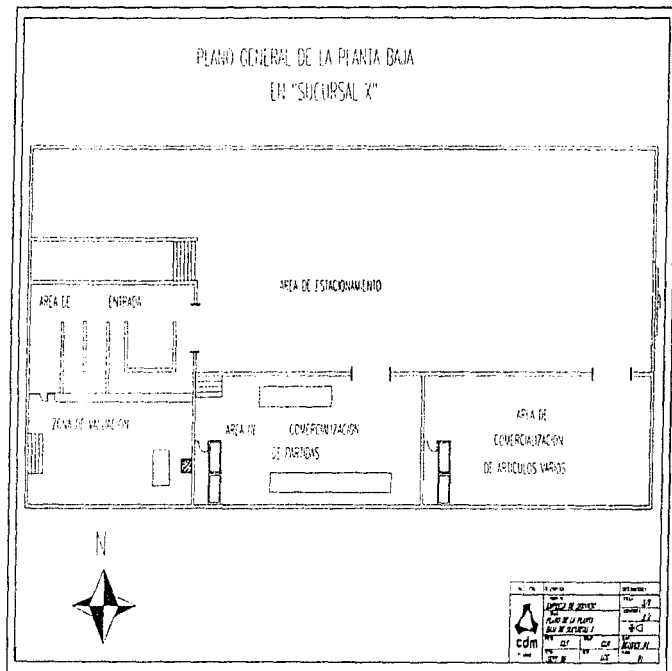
Distribución de la planta baja en la "Sucursal X".
